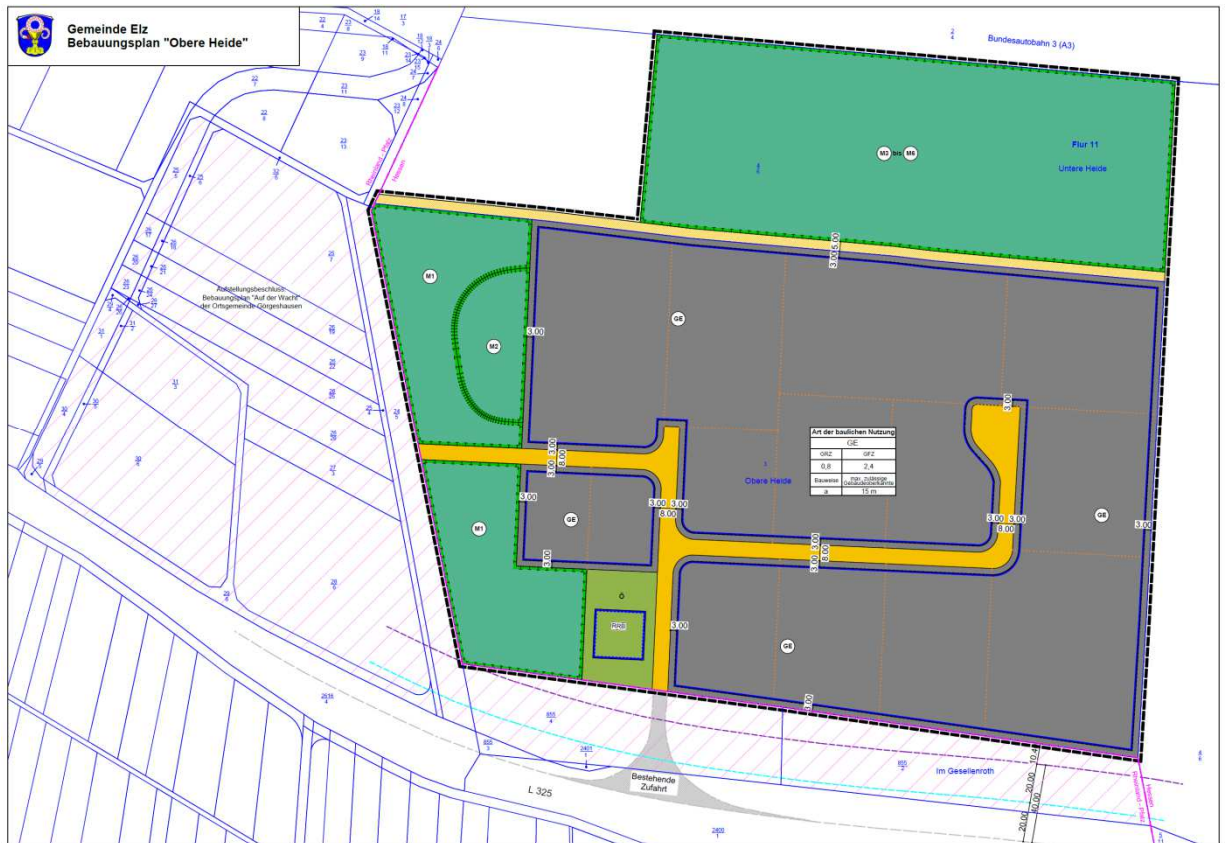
Entwurf zum Bebauungsplan „Obere Heide“ (Planteil).
